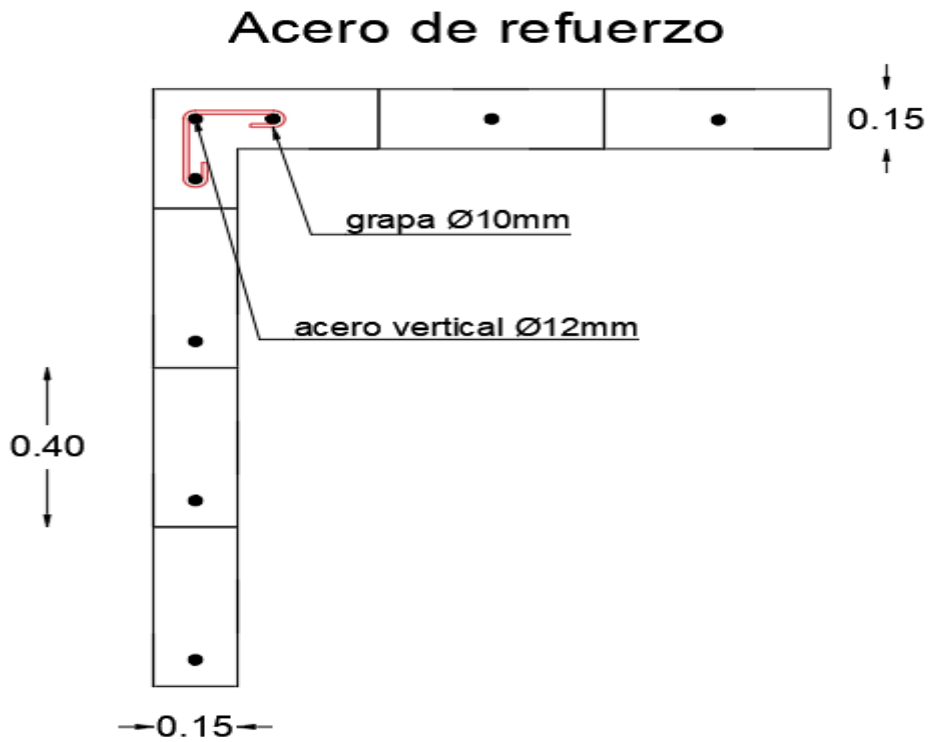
Acero de refuerzo en la hilada tipo LL
